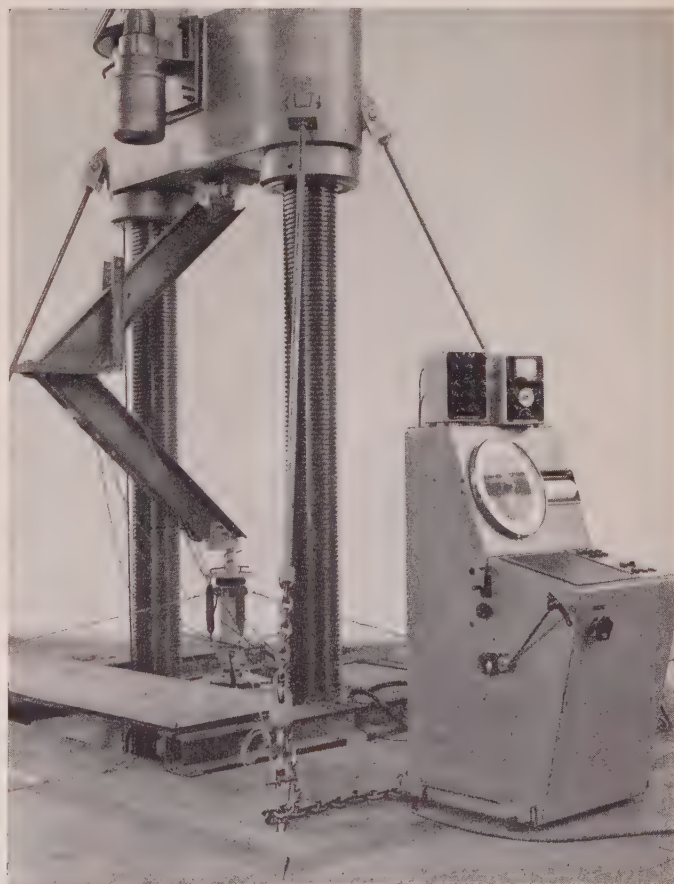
Großversuche an einer Rahmenecke mit einer Schenkellänge von 1,48 m
